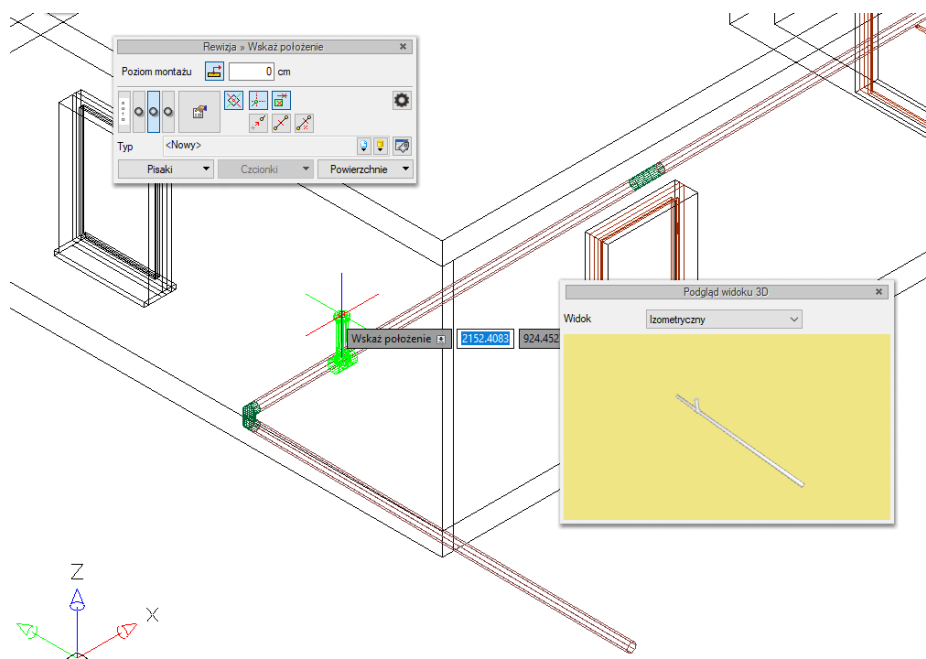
Przykład rysowania rur w widoku CAD 3D
